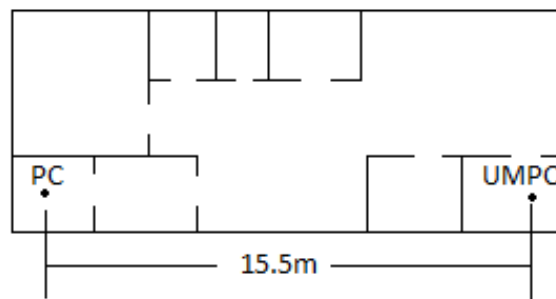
Plano arquitectónico de la casa donde se realizaron las pruebas.
